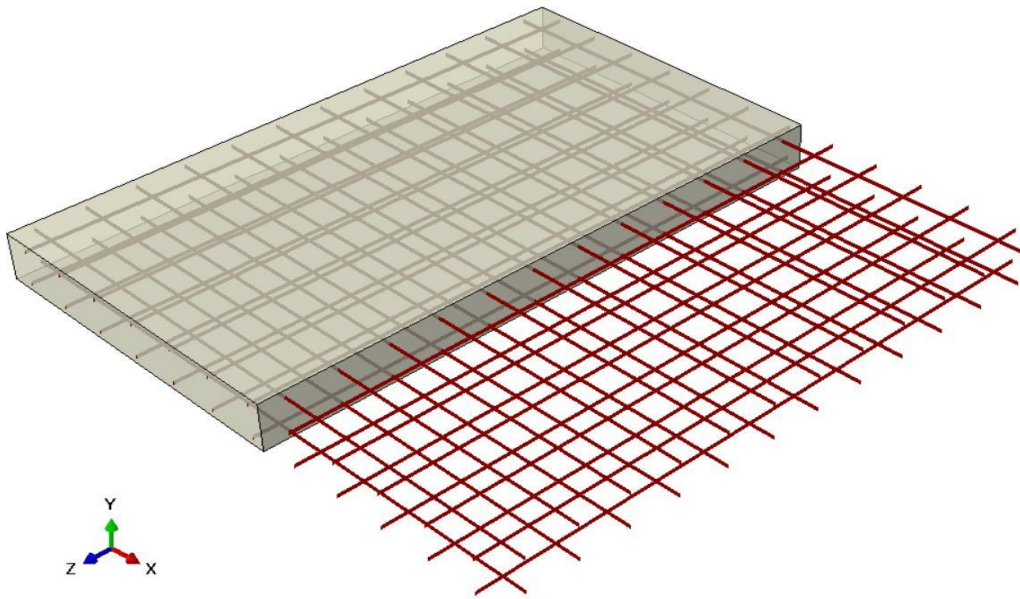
PK1011 beton plağın sonlu eleman ağı
